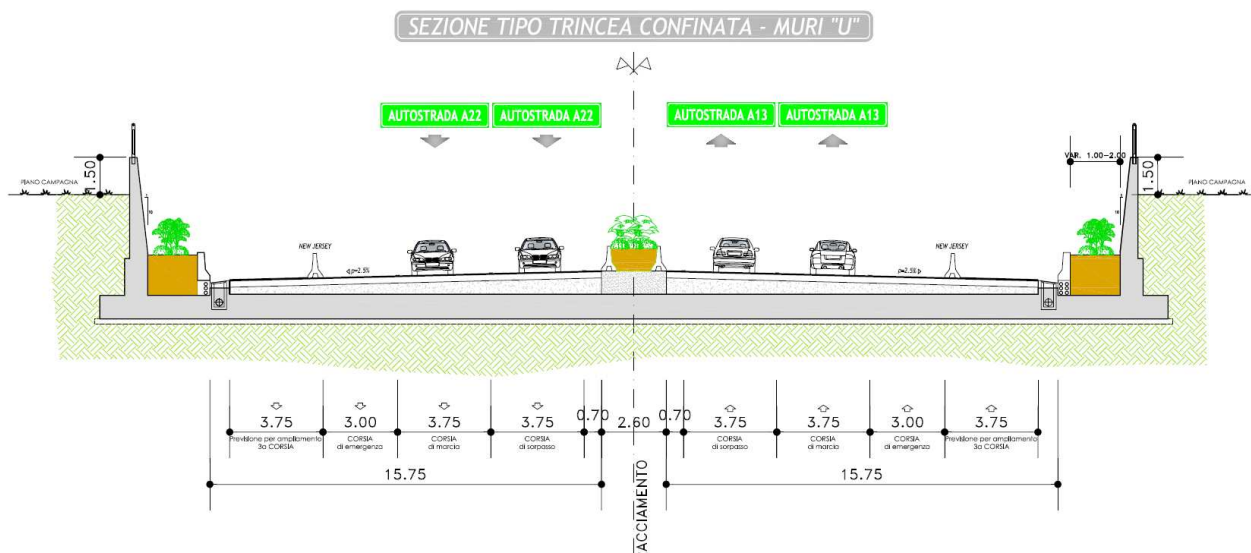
SEZIONE TIPO IN TRINCEA CONFINATA
